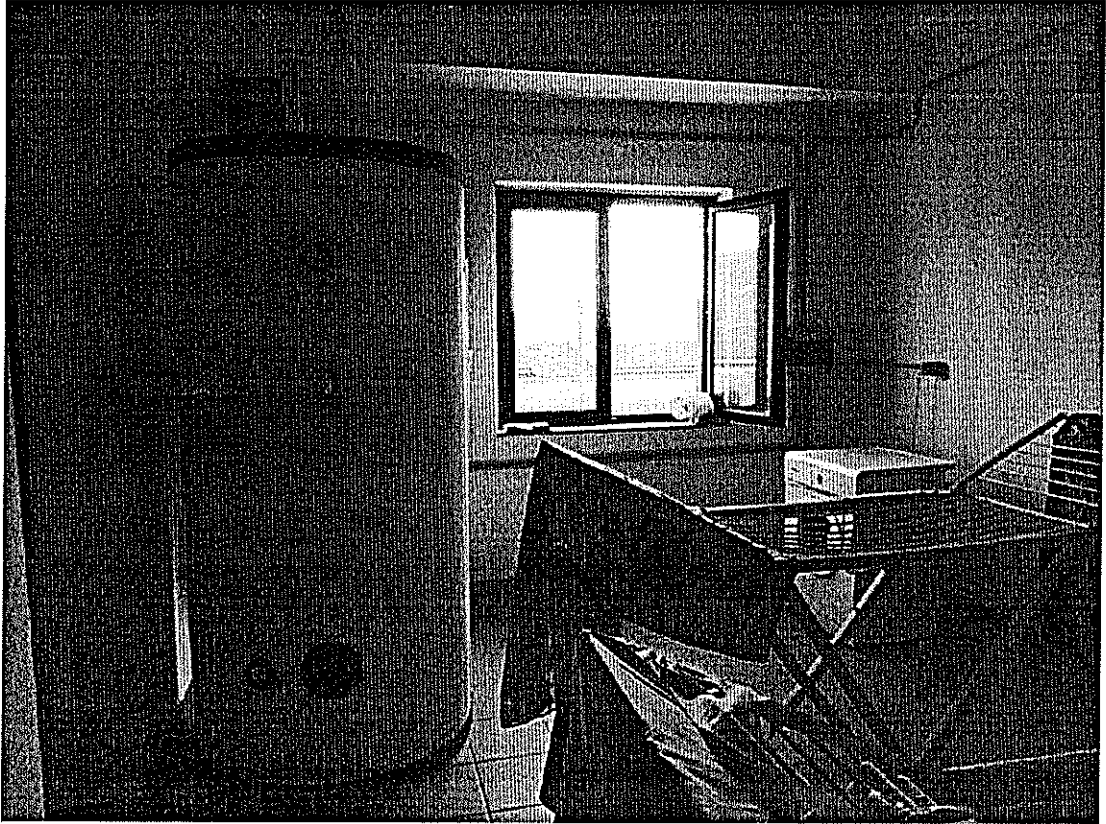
Deposito pulito del primo corpo di fabbrica – piano terra.
